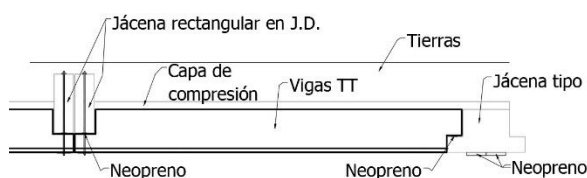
Detalle general de apoyo de vigas en Proyecto.
